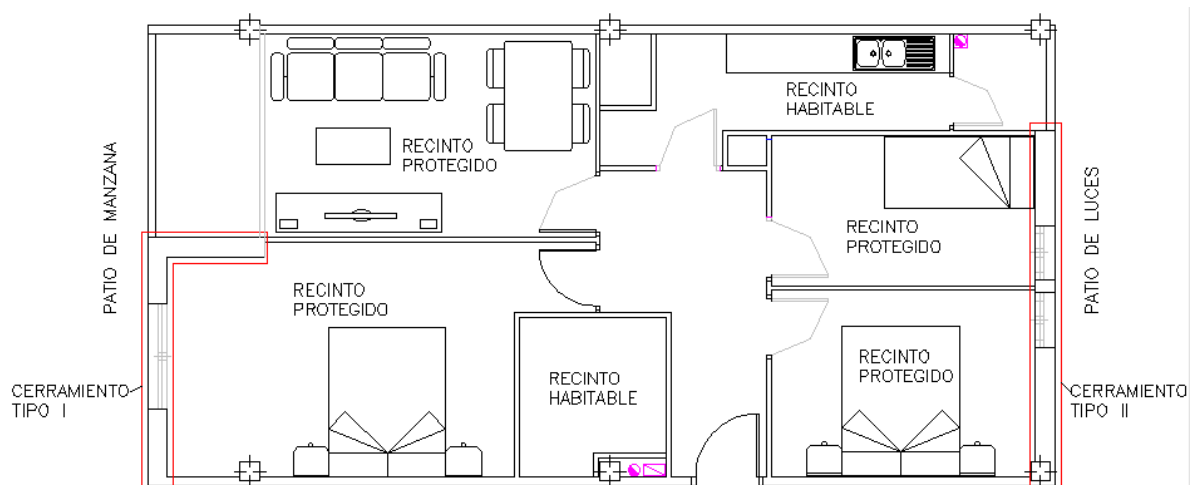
Detalle Cerramientos que deberían cumplir las exigencias de aislamiento acústico en obra nueva.
